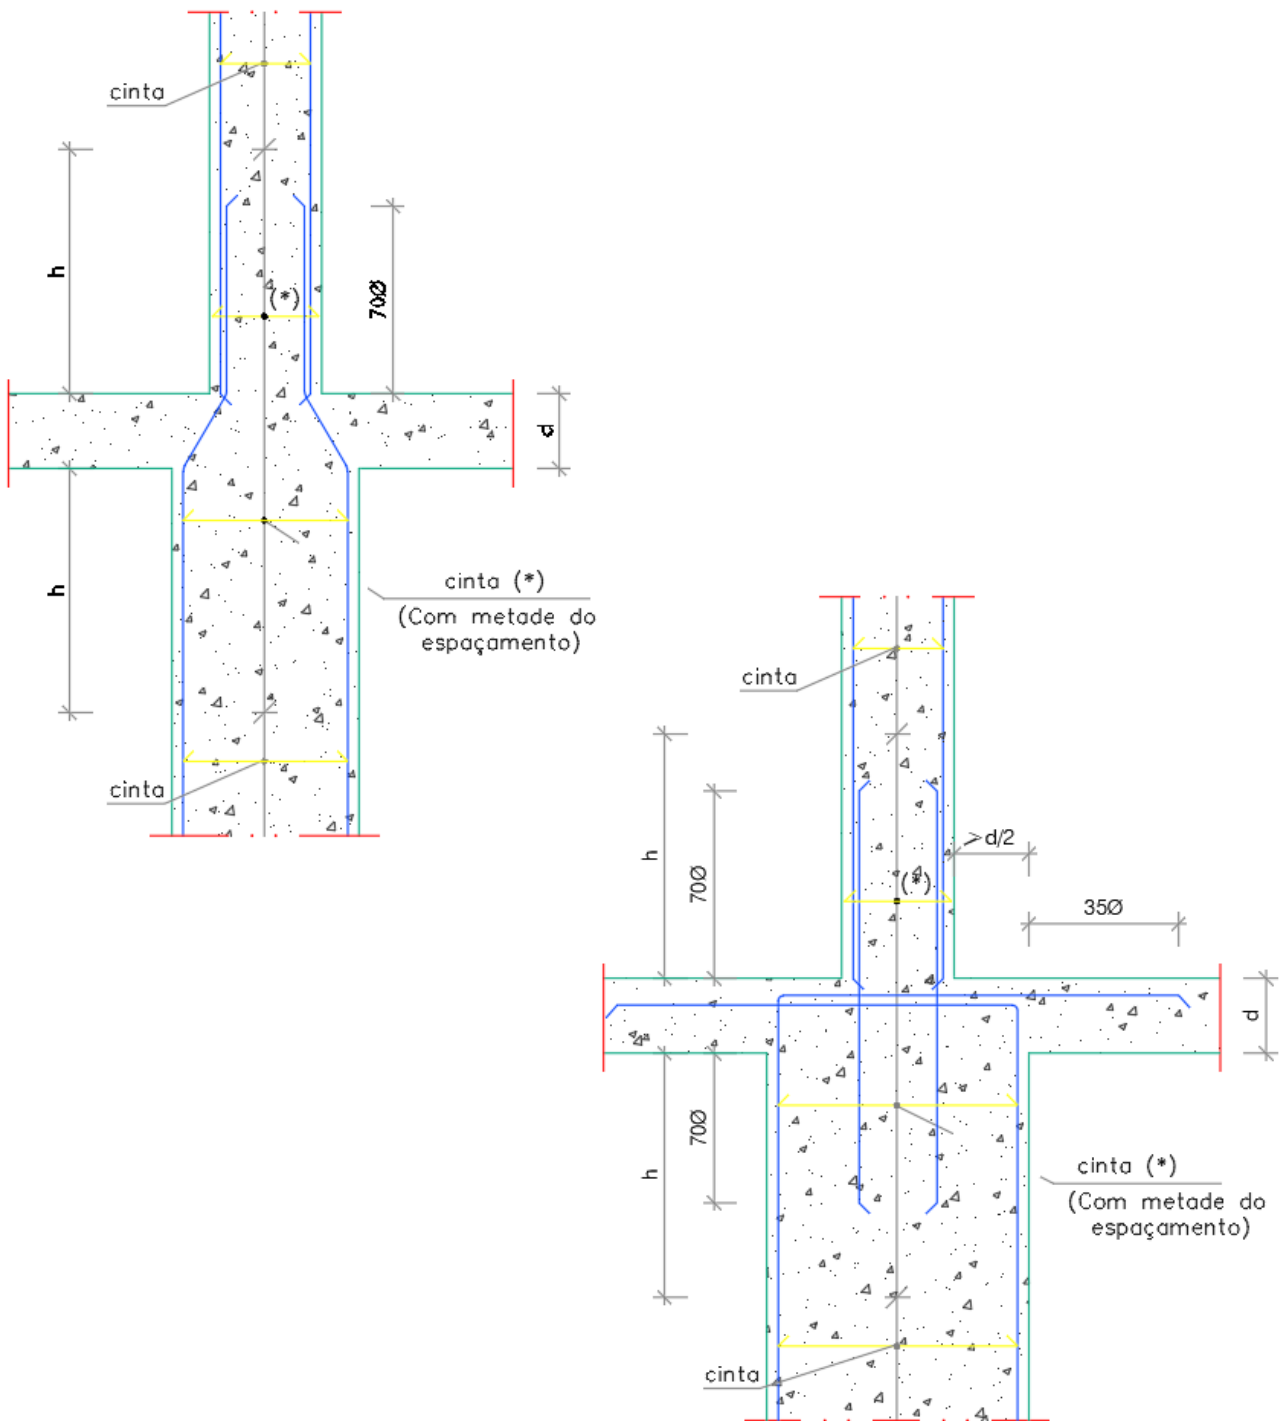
Pilares com seção variável (Projeto de estruturas).
